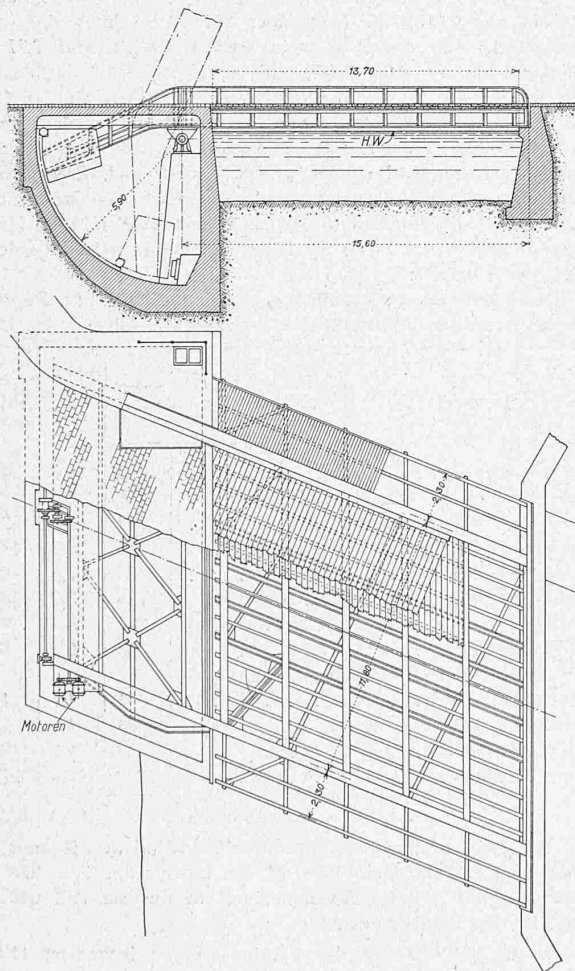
und 2. Grundriss (Draufsicht) und Längsschnitt. — 1:300.
